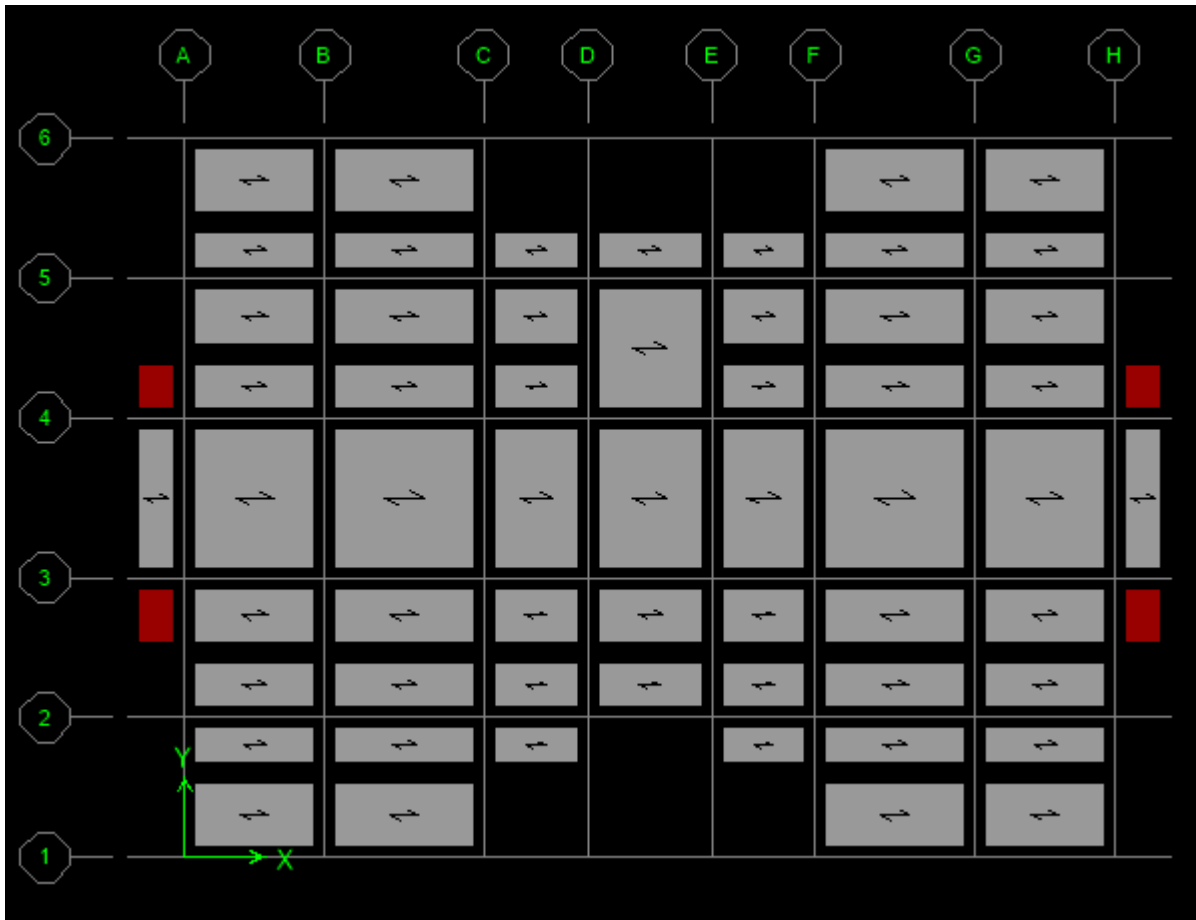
Plancher à corps creux, Dalle pleine
